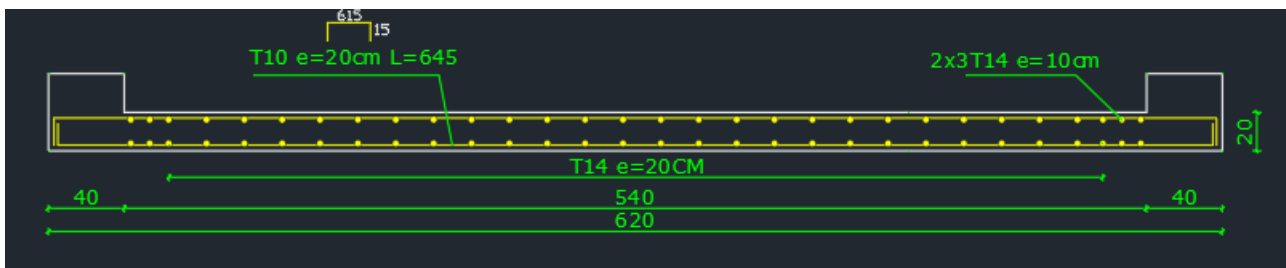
dispositions du ferrailage longitudinal du voile.
